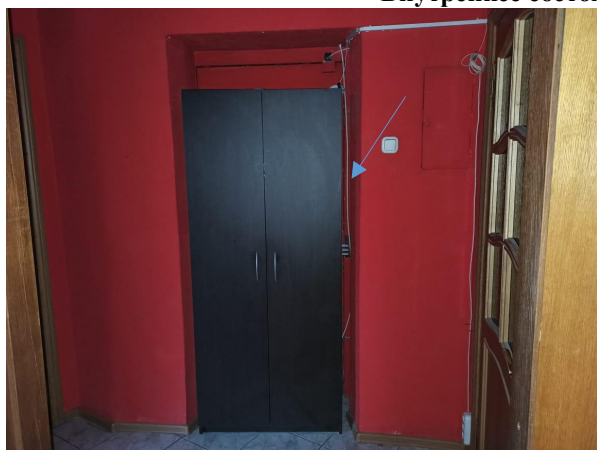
Вид со стороны помещения на вход в помещение с 1 ЛК
